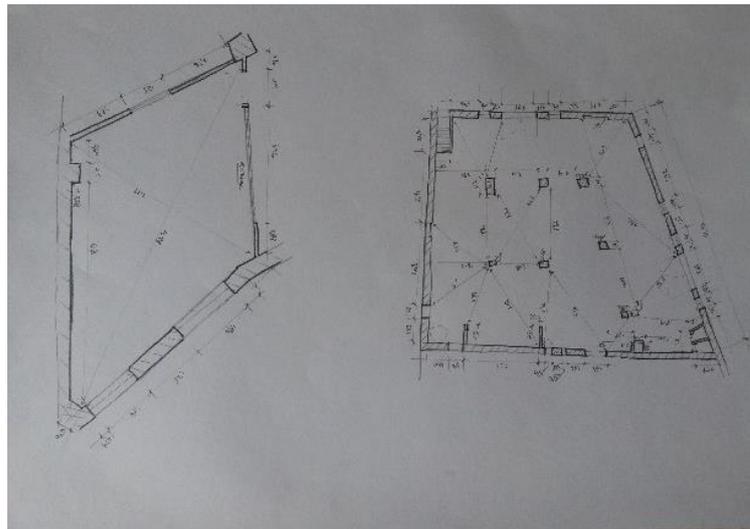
Croquizado de oficina planta baja y almacén planta primera. Fuente Propia.
